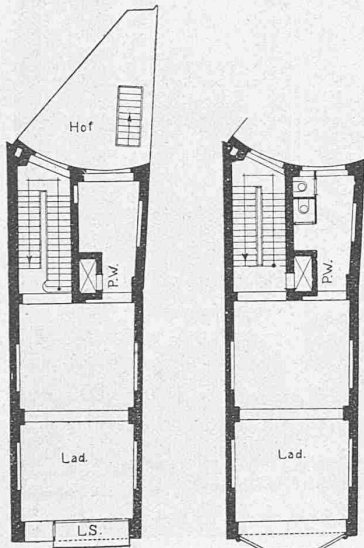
u. 24. Erdgeschoss. I. Obergeschoss.
